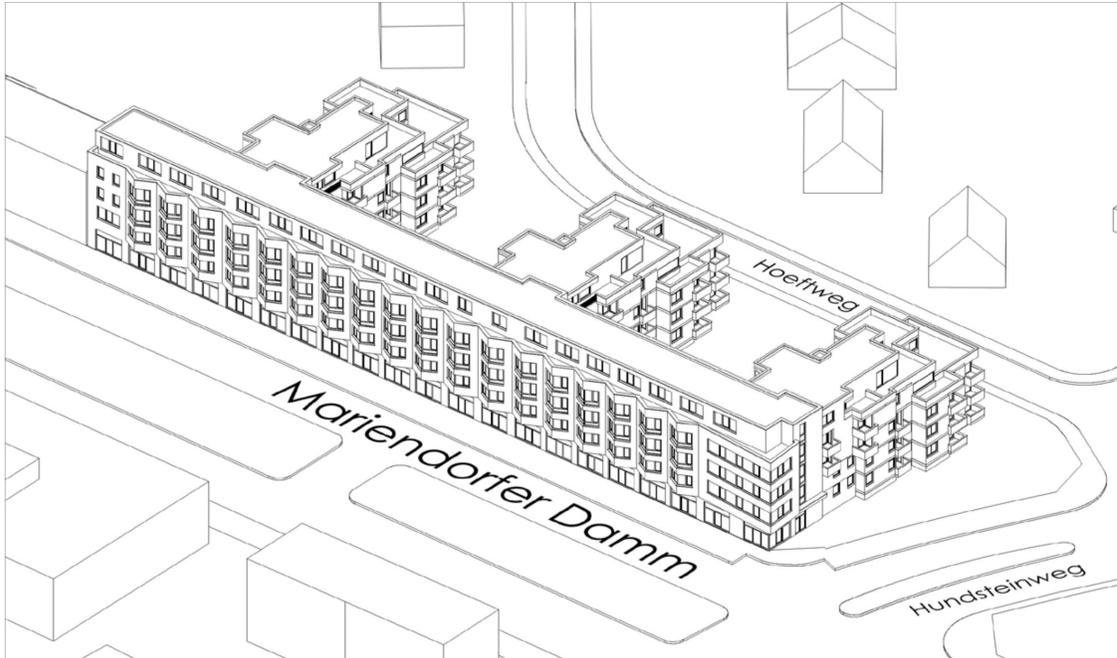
Isometrie des geplanten Baukörpers; Quelle: büro13 Architekten
